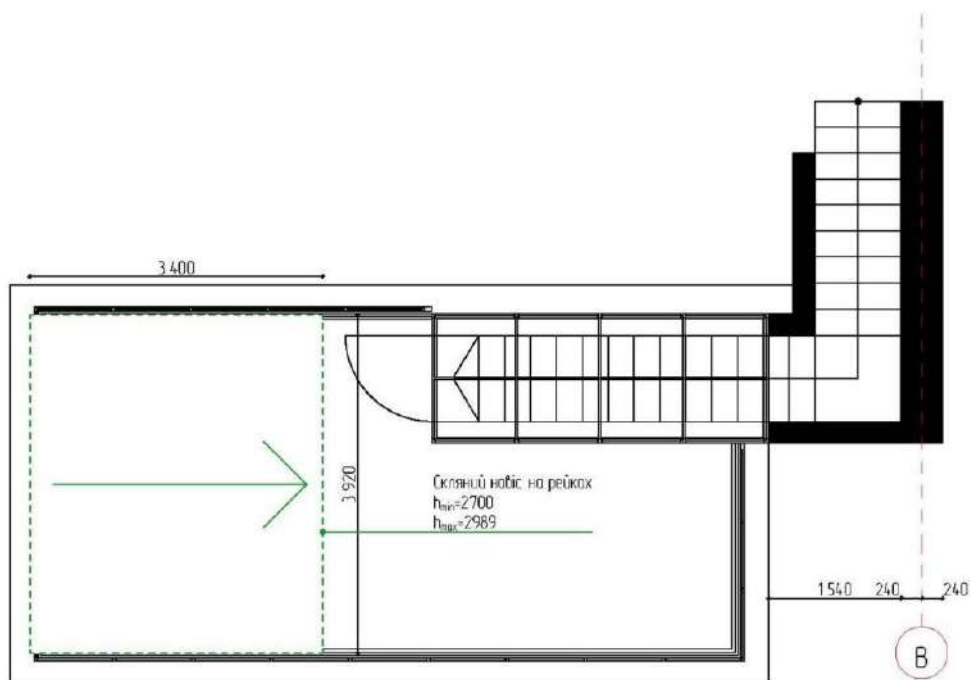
План монтажу тераси (авторське креслення).
